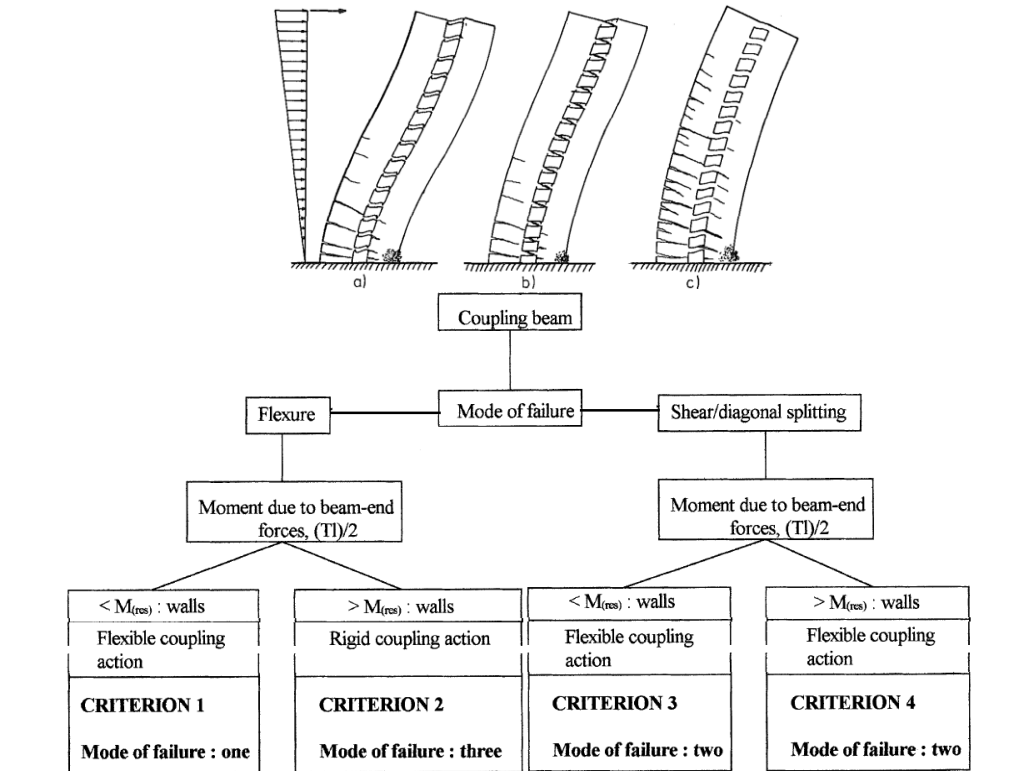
Moduri de cedare a pereților cuplați din beton armat cu goluri centrale [29] [30]
